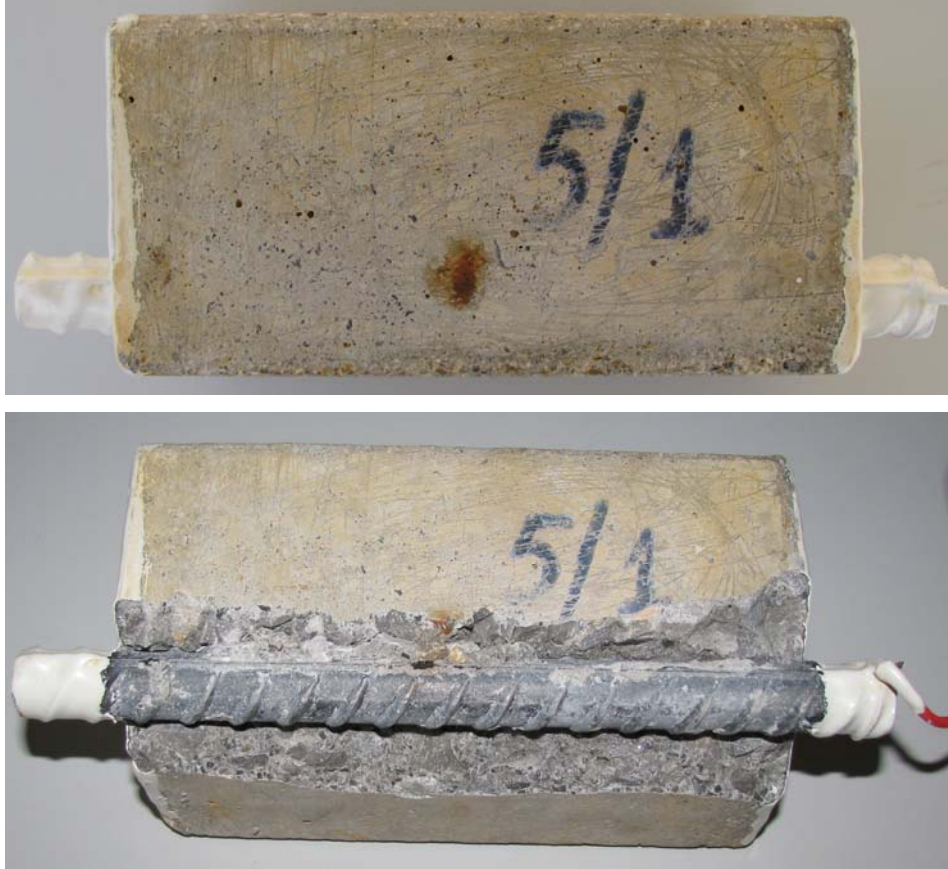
Betonarme örneklerde klorür etkisi sebebiyle lokal korozyon gelişimi.
